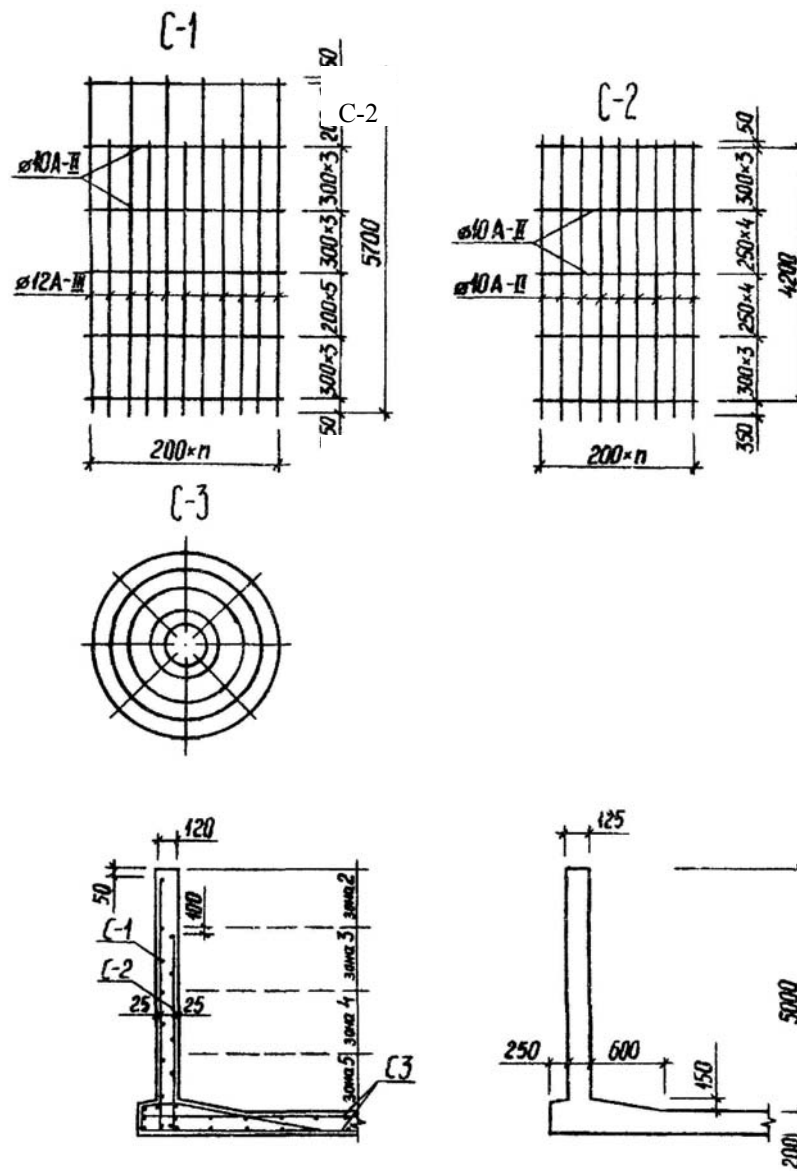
Схема армирования монолитного железобетонного резервуара
